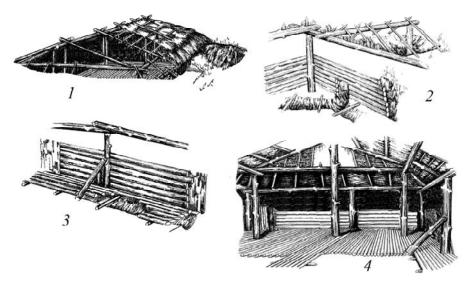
Графическая реконструкция конструктивных элементов жилища № 14 (Мергень 6): 1— возможный вариант кровли; 2, 3— вариант обшивки стен котлована и рва; 4— вариант внутреннего устройства жилища (реконструкции выполнены Д.А. Белоноговым)
